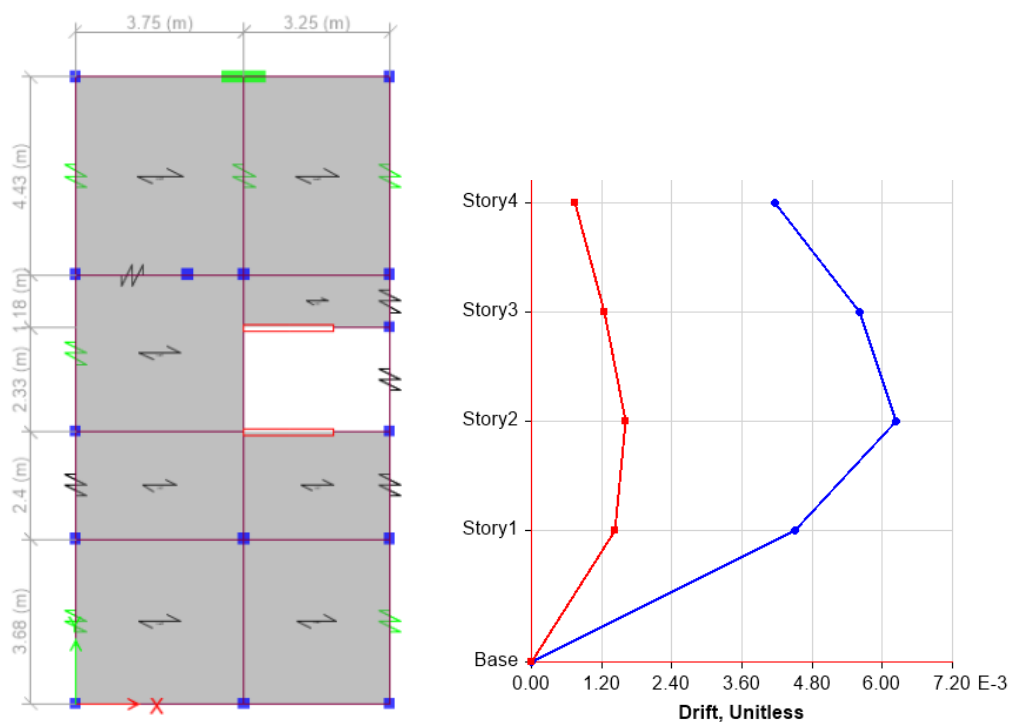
Propuesta de reforzamiento de elementos estructurales presentes en la edificación analizada. Fuente: Elaboración propia.
